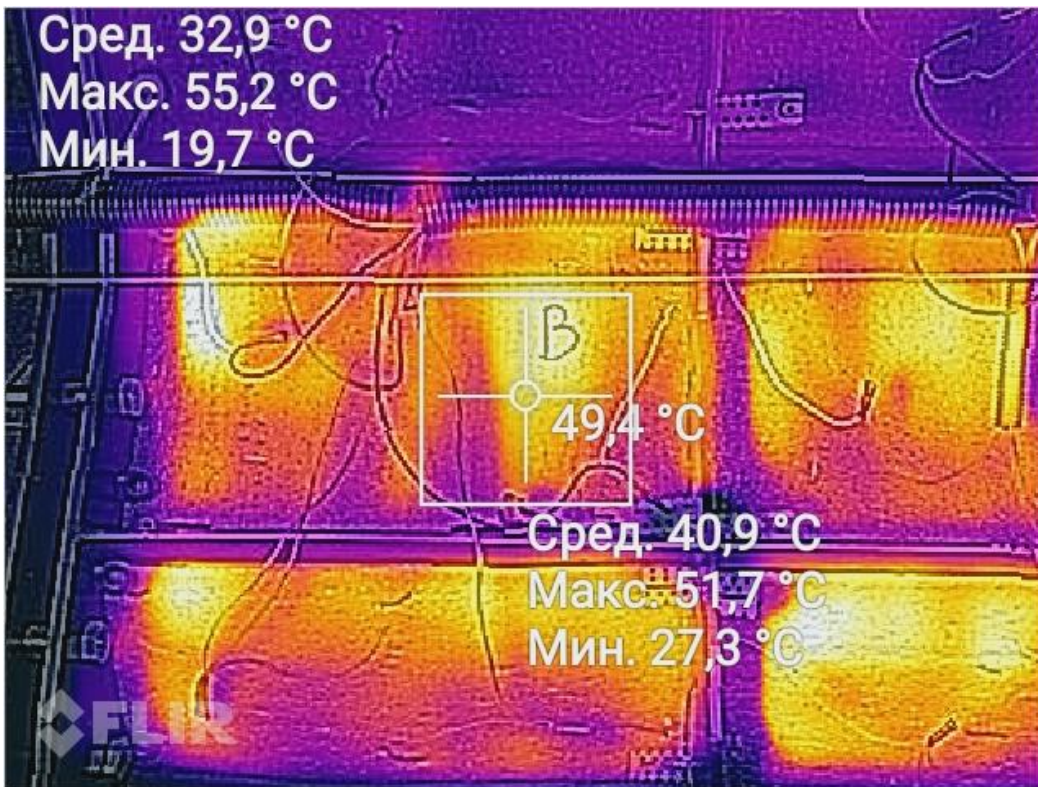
тепловой снимок нагревательного элемента с края опалубки
